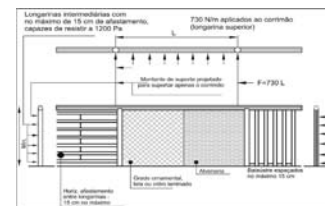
Pormenores construtivos da instalação de guardas e as cargas a que elas devem resistir
